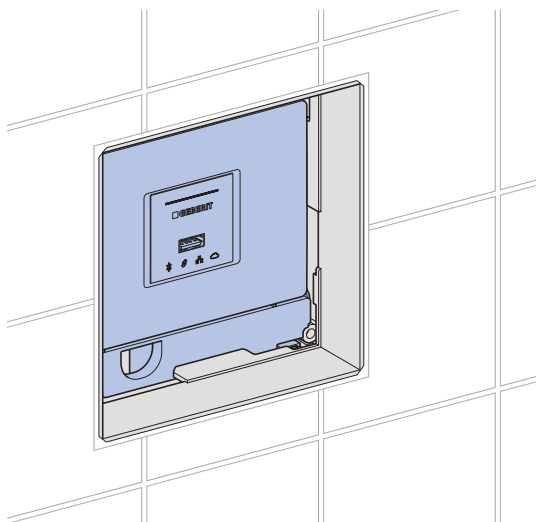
Montaggio nel telaio di supporto per montaggio grezzo
